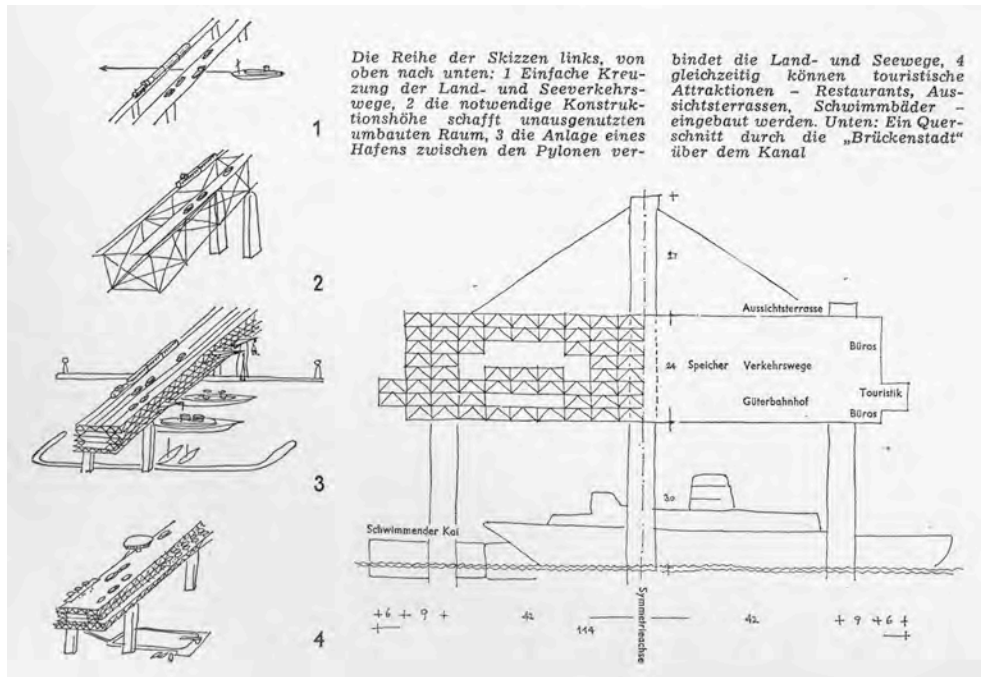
Ärmelkanal-Brückenstadt (Bauwelt 54.1963)
